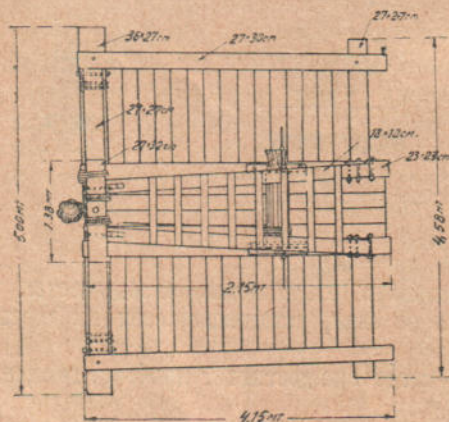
120. Типовой чертеж приспособления для вытаскивания свай, примененного при разборке перемычки 3-й очереди плотины черепановских сооружений в 1923—1924 г.
